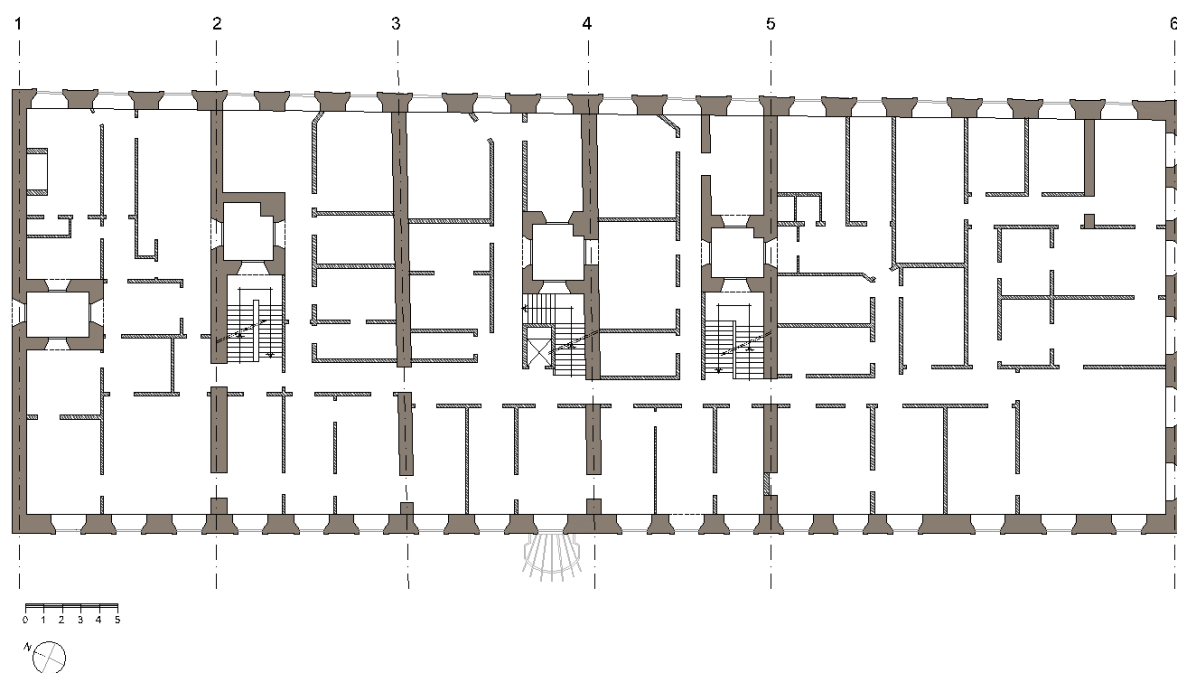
Planta do Piso 2 – (Levantamento do Existente)
